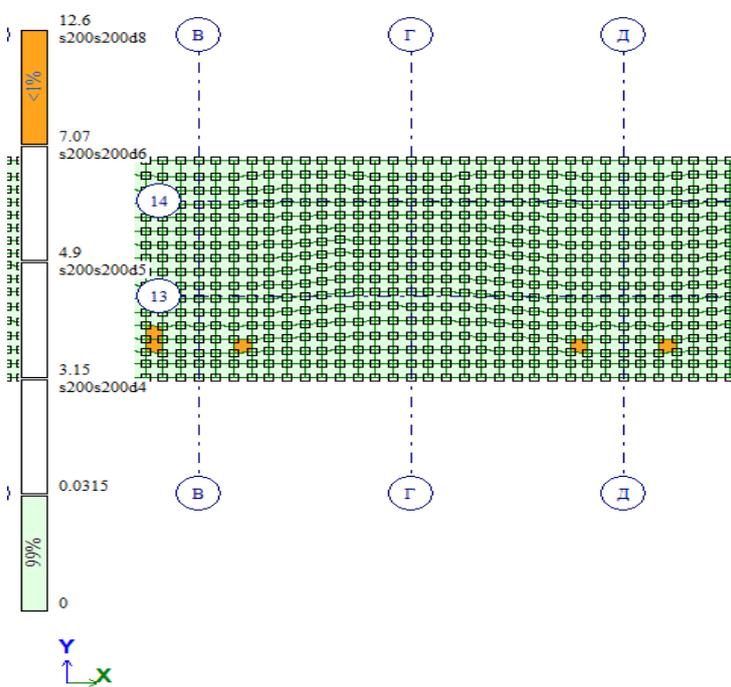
Нижнее армирование по двум направлениям в фундаментной ленте.
